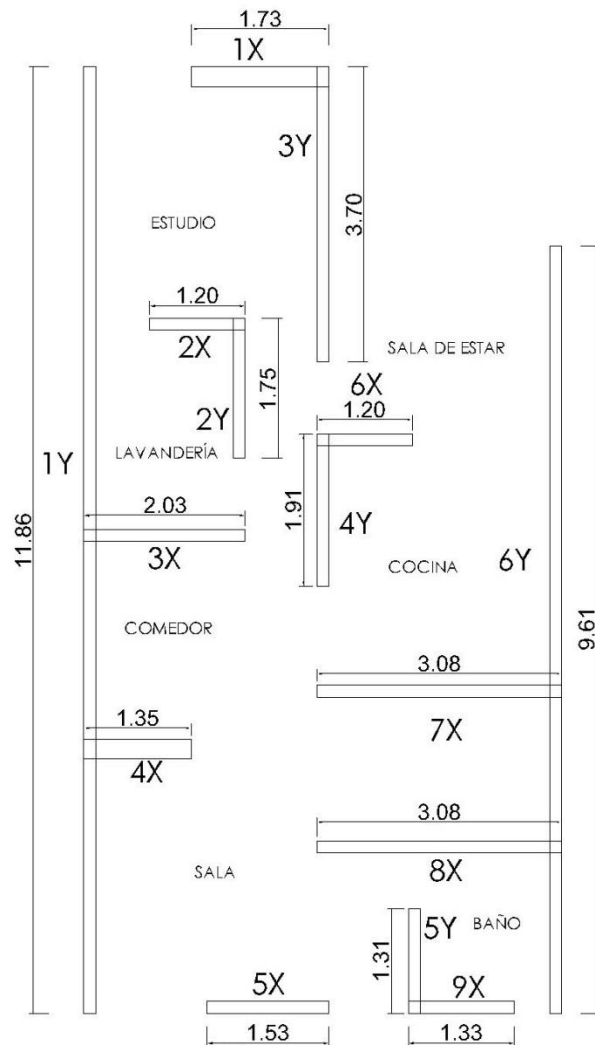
3. Distribución de muros portantes en la planta del primer piso
